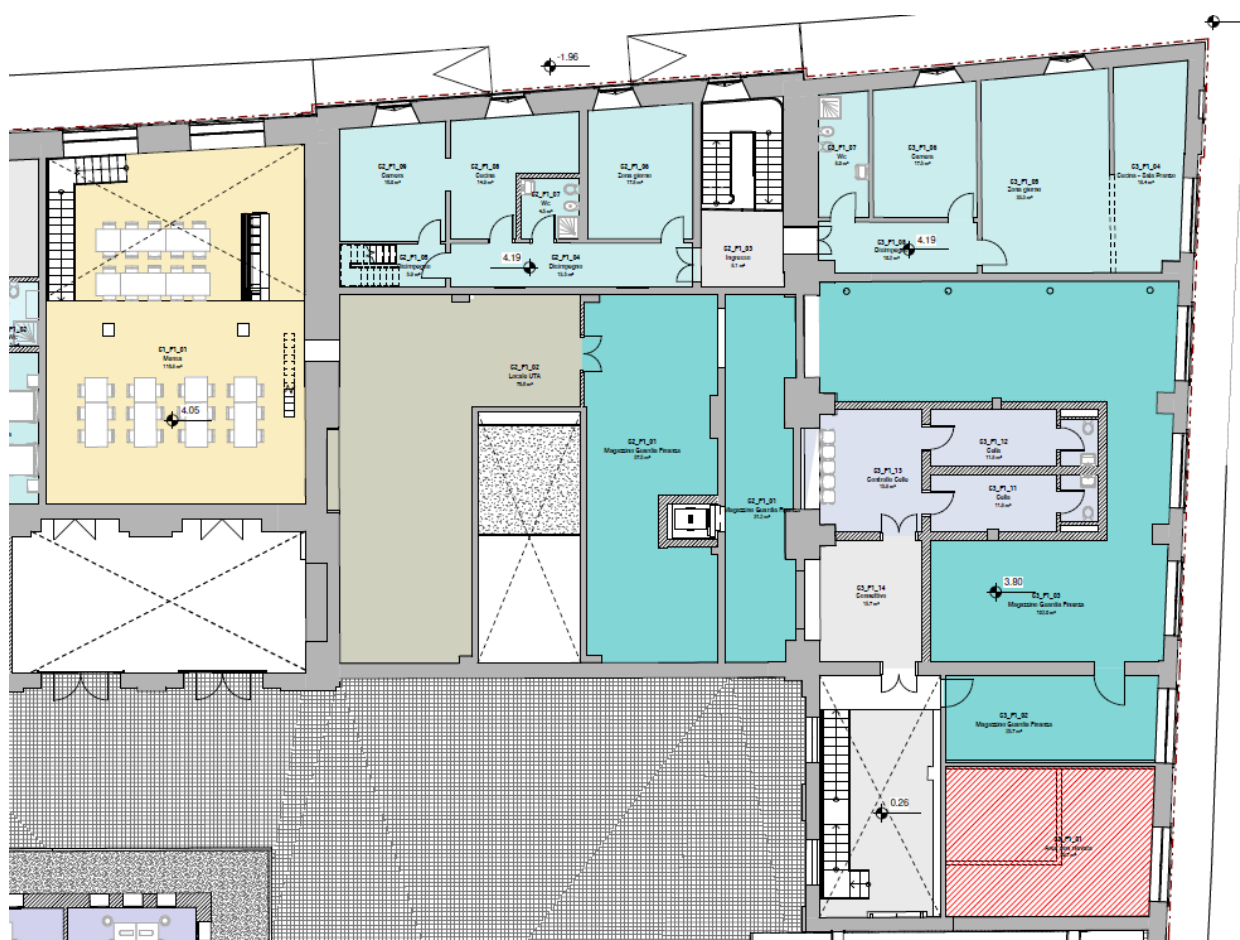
Edificio C2, pianta piano primo – estratto della pianta con le indicazioni funzionali
